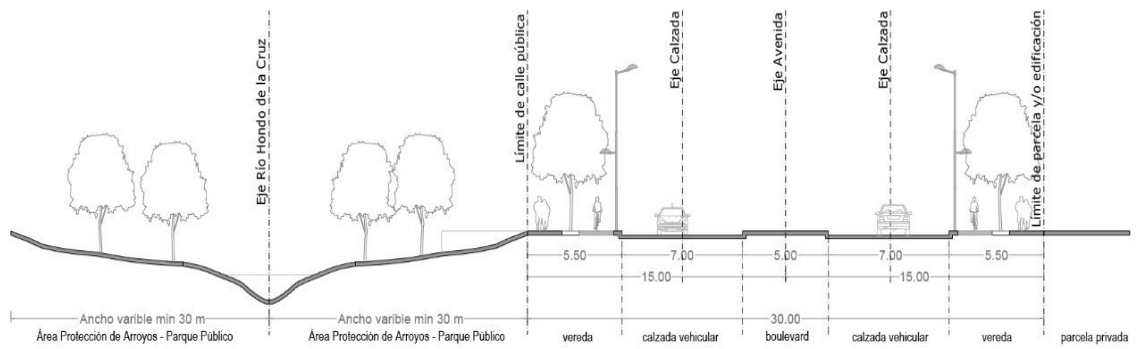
Sección transversal de Vías Especiales Tipo 2.
